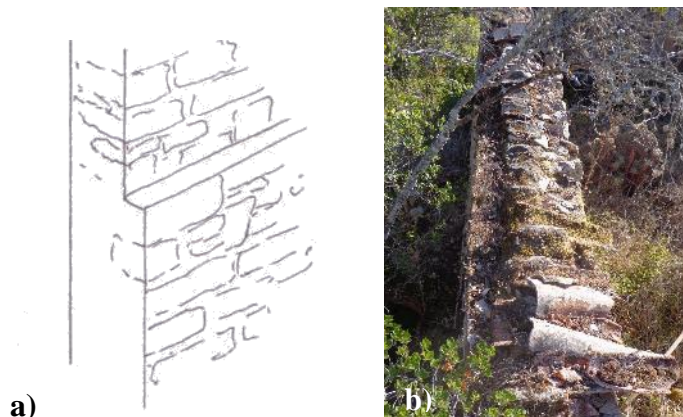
a) Diminuição da secção da cobertura para assentamento de sobrado; b) Diminuição da secção da parede para assentamento da cobertura
